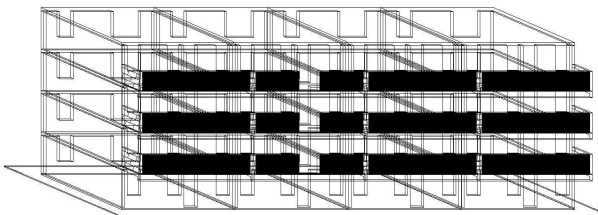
Pasos del proceso constructivo con prefabricados estructurales.
